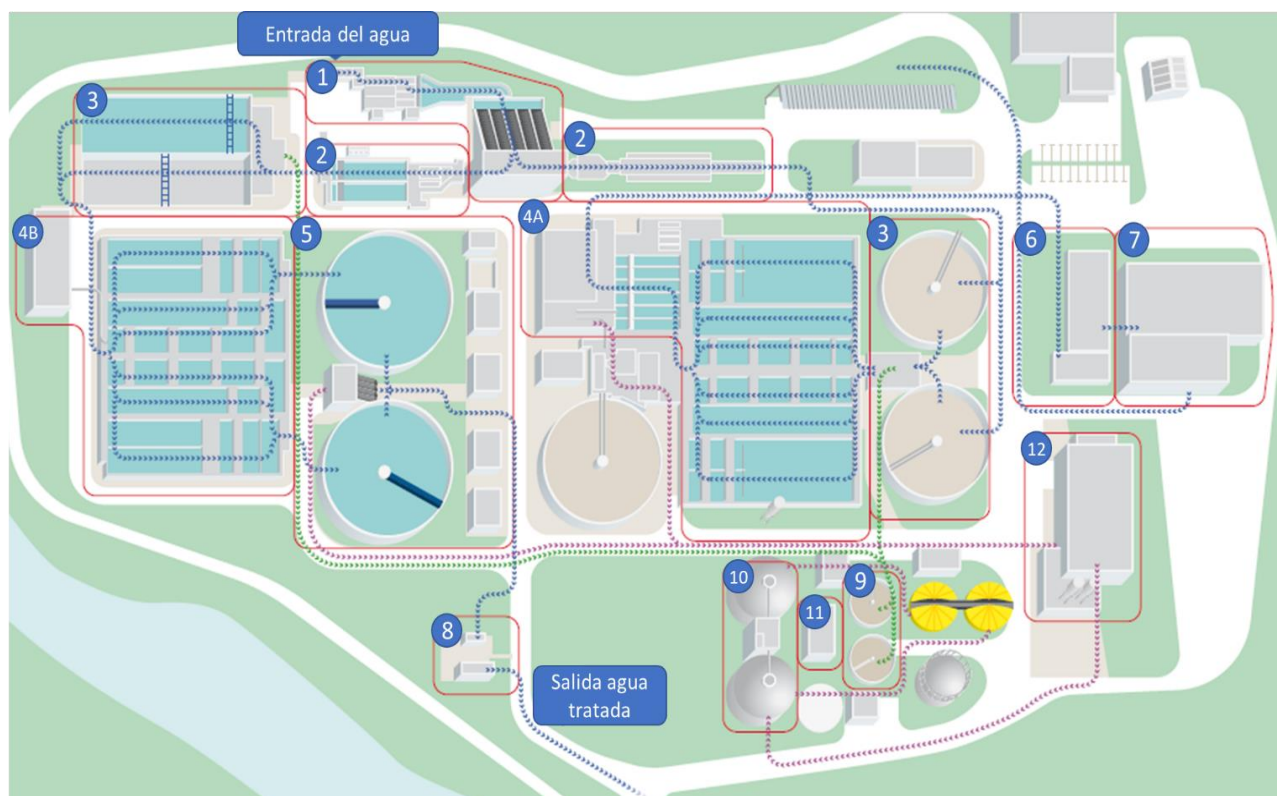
Esquema planta EDAR Gavà-Viladecans.
